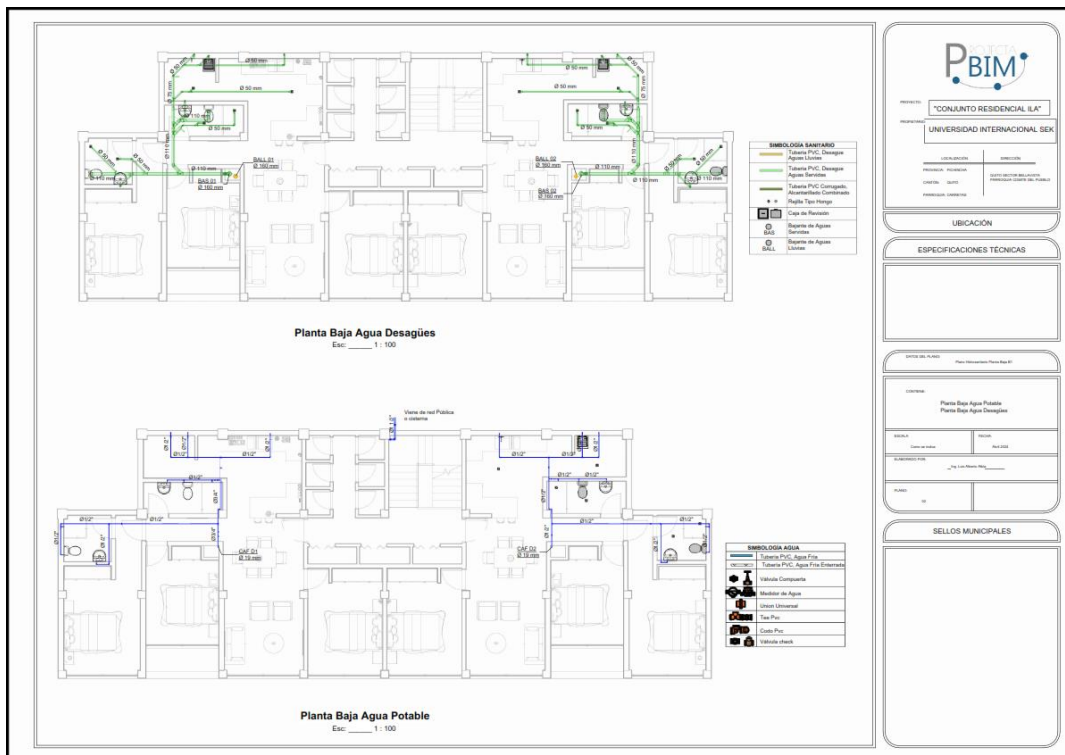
Plano Hidrosanitario Planta Baja B1
